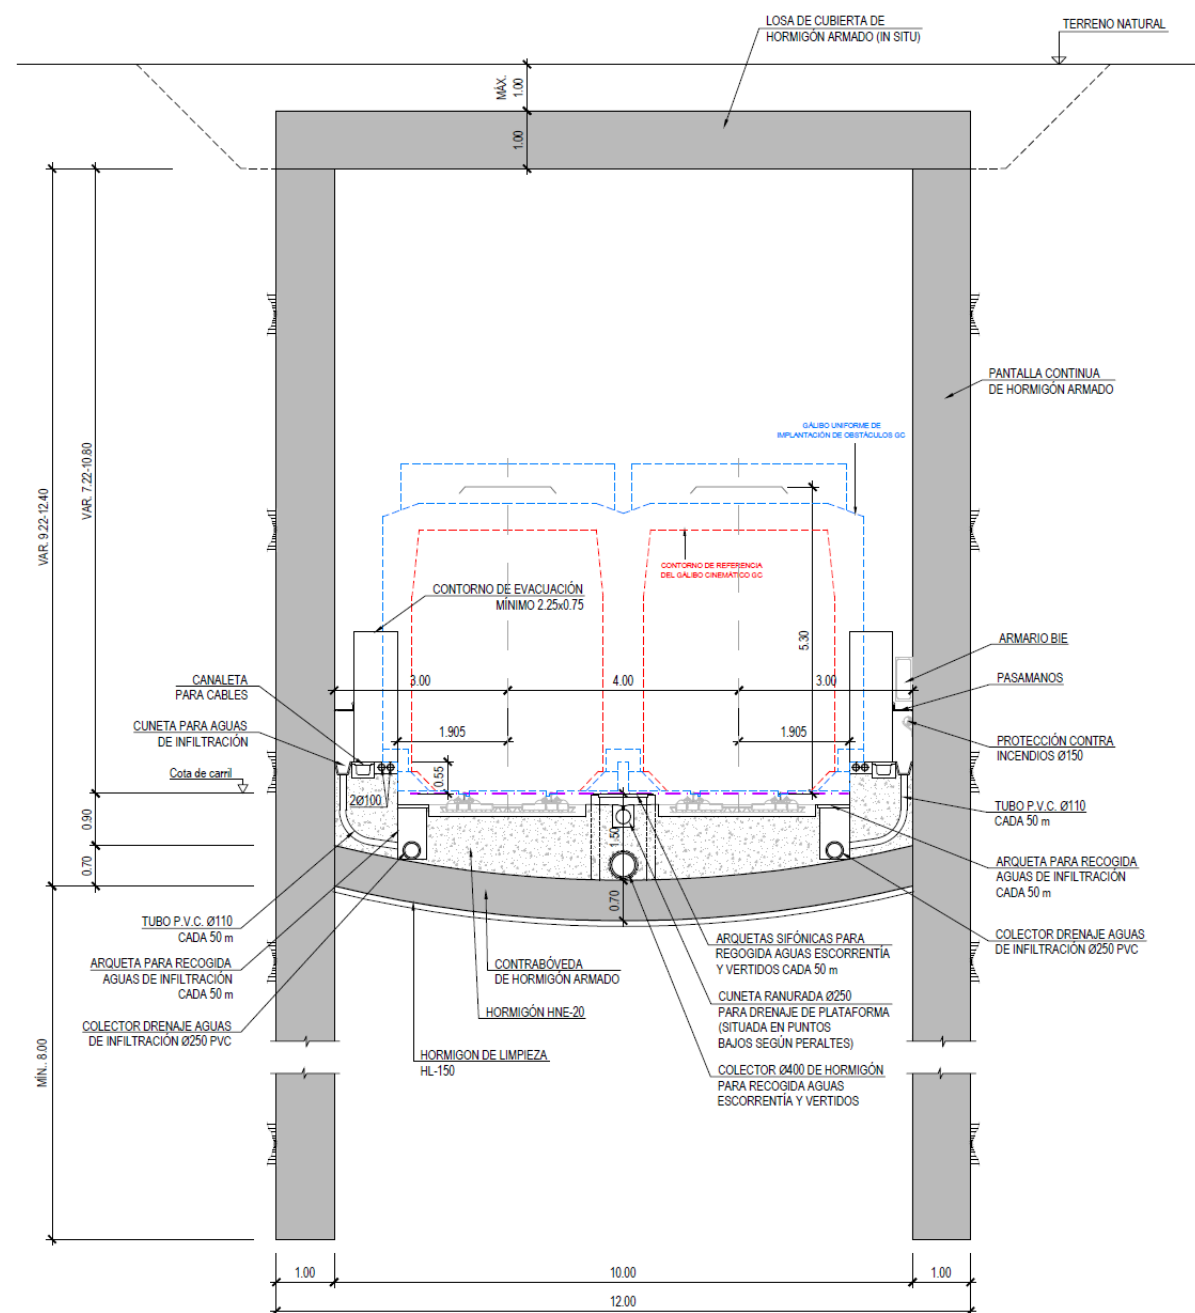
b.- Sección tipo 2 en el tramo soterrado (ST-S2).
